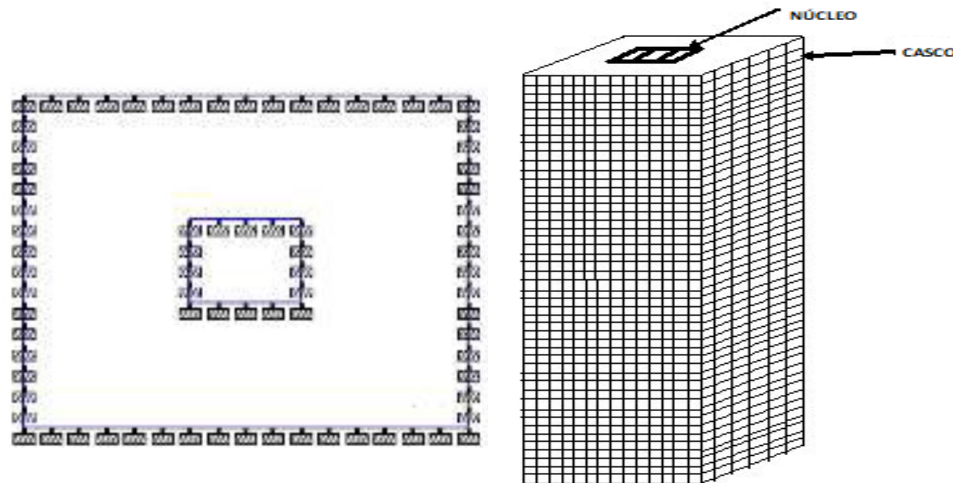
Planta y elevación del sistema tubo en tubo (Ramasubramani, Pennarasi, y Sivakamasundari, 2019)
